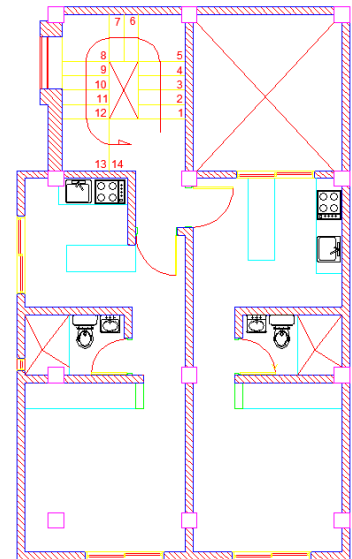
Planta tipo de los pisos 2, 3 y 4.
